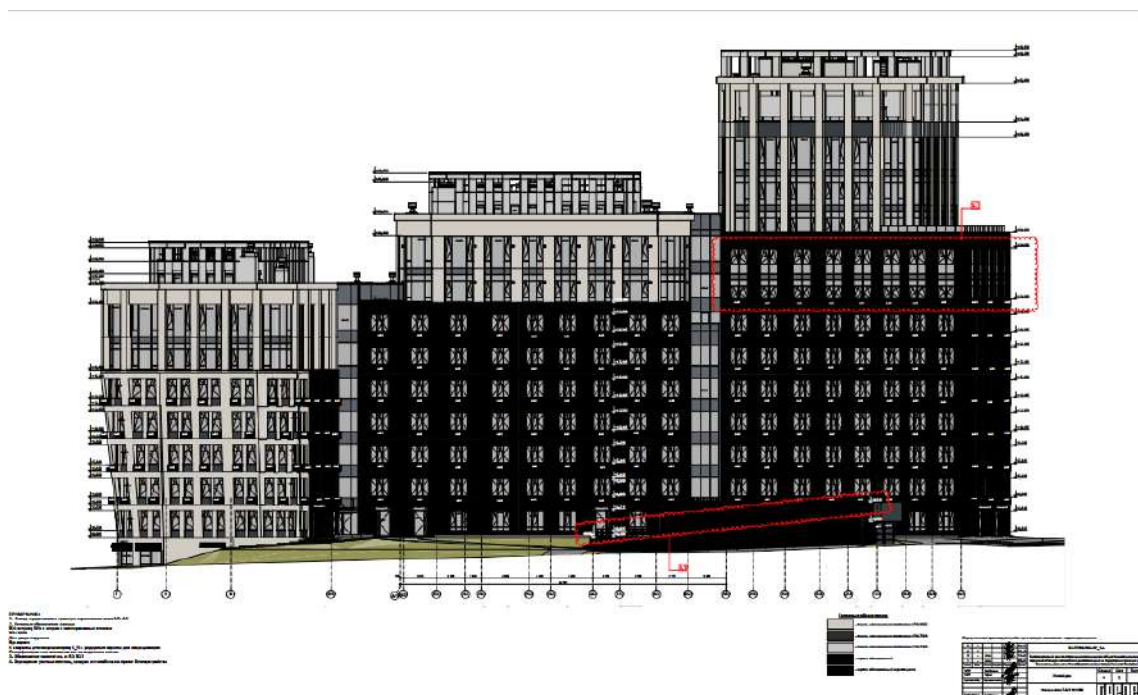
Фасад КМ Дом на Барминской, выполненный из крупных панелей.
